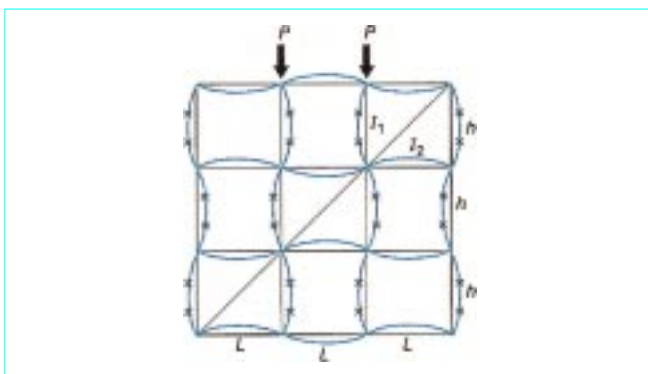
Système triangulé. Flambement local du poteau. Nœud à semi-encastrement
